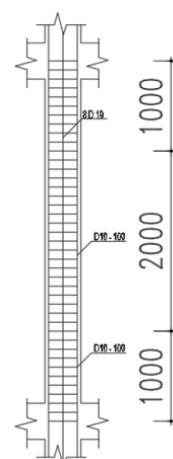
Potongan Detail Tulangan Balok Portal Sumbu Y AS 5
